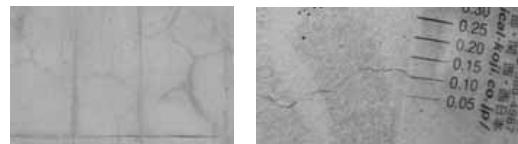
P5に発生した不規則な格子状ひび割れ
